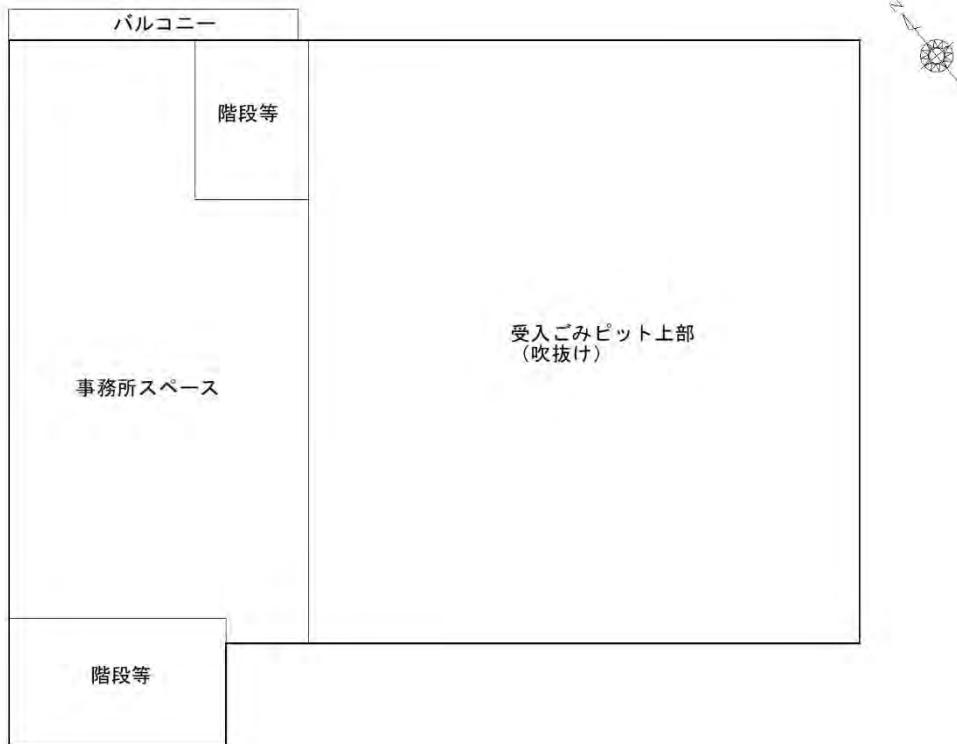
(7) 廃棄物受入棟平面図 (6階)
